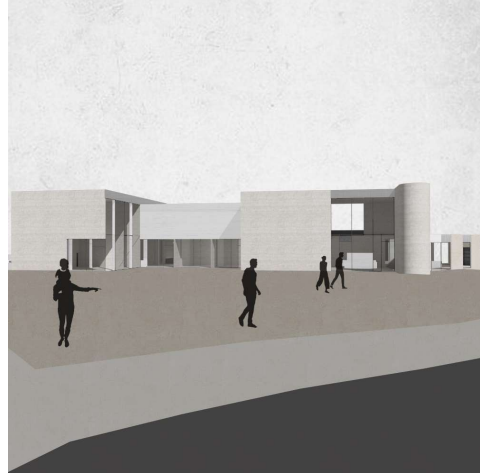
Proyecto final: vista ingreso. Elaboración propia.
